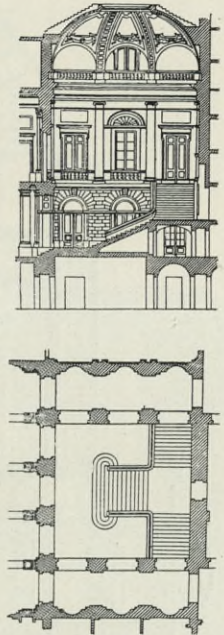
Stadttheater zu Bordeaux. Grundriß u. Schnitt des Haupttreppenhauses.<sup>48)</sup>
